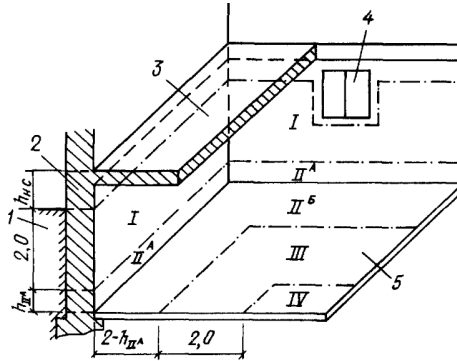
Разбивка заглубленных частей наружных стен и пола углового подвального помещения на I-IV расчетные зоны: 1-земля; 2-наружная стена; 3-перекрытие; 4-окно; 5-пол
